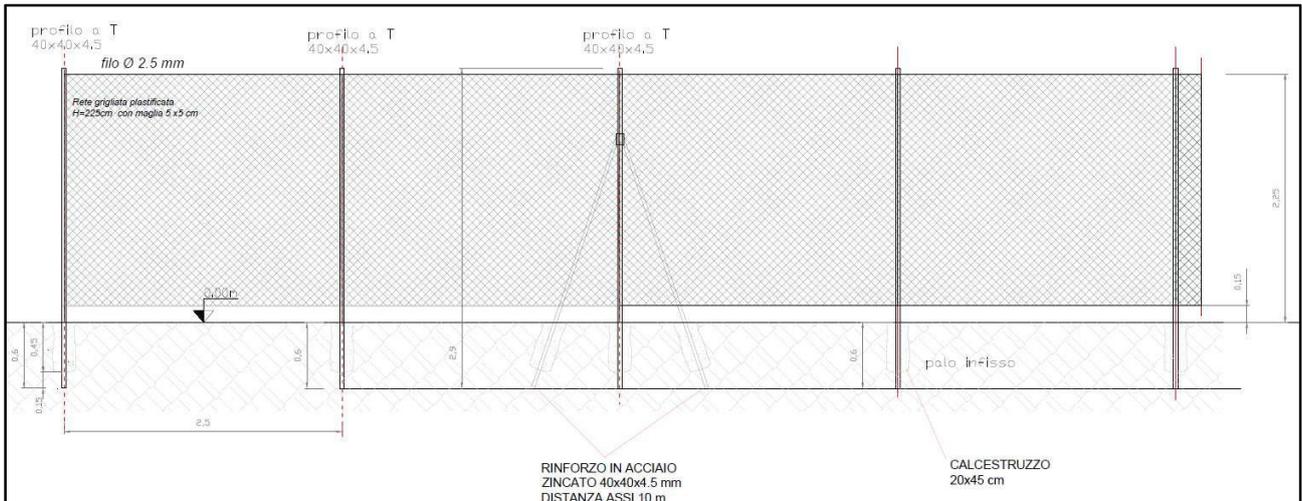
particolare pannello recinzione con rete grigliata plastificata, sollevata di 15 cm dal suolo per il passaggio della piccola fauna.
